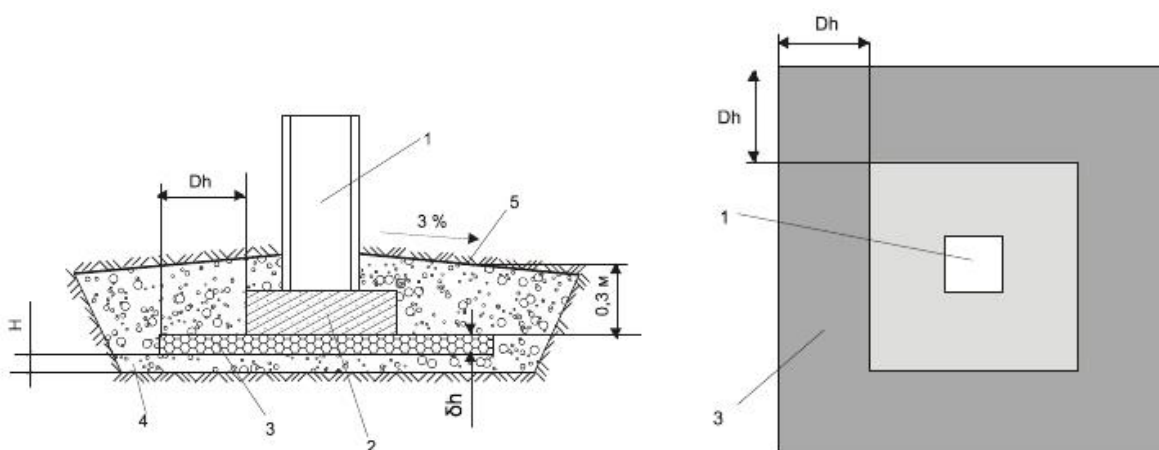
Схема укладки и параметры теплоизоляции в фундаментах отдельно стоящих опор: 1-опора; 2-фундамент; 3-теплоизоляционный слой; 4-песчано-гравийная смесь; 5-водоупорный слой
